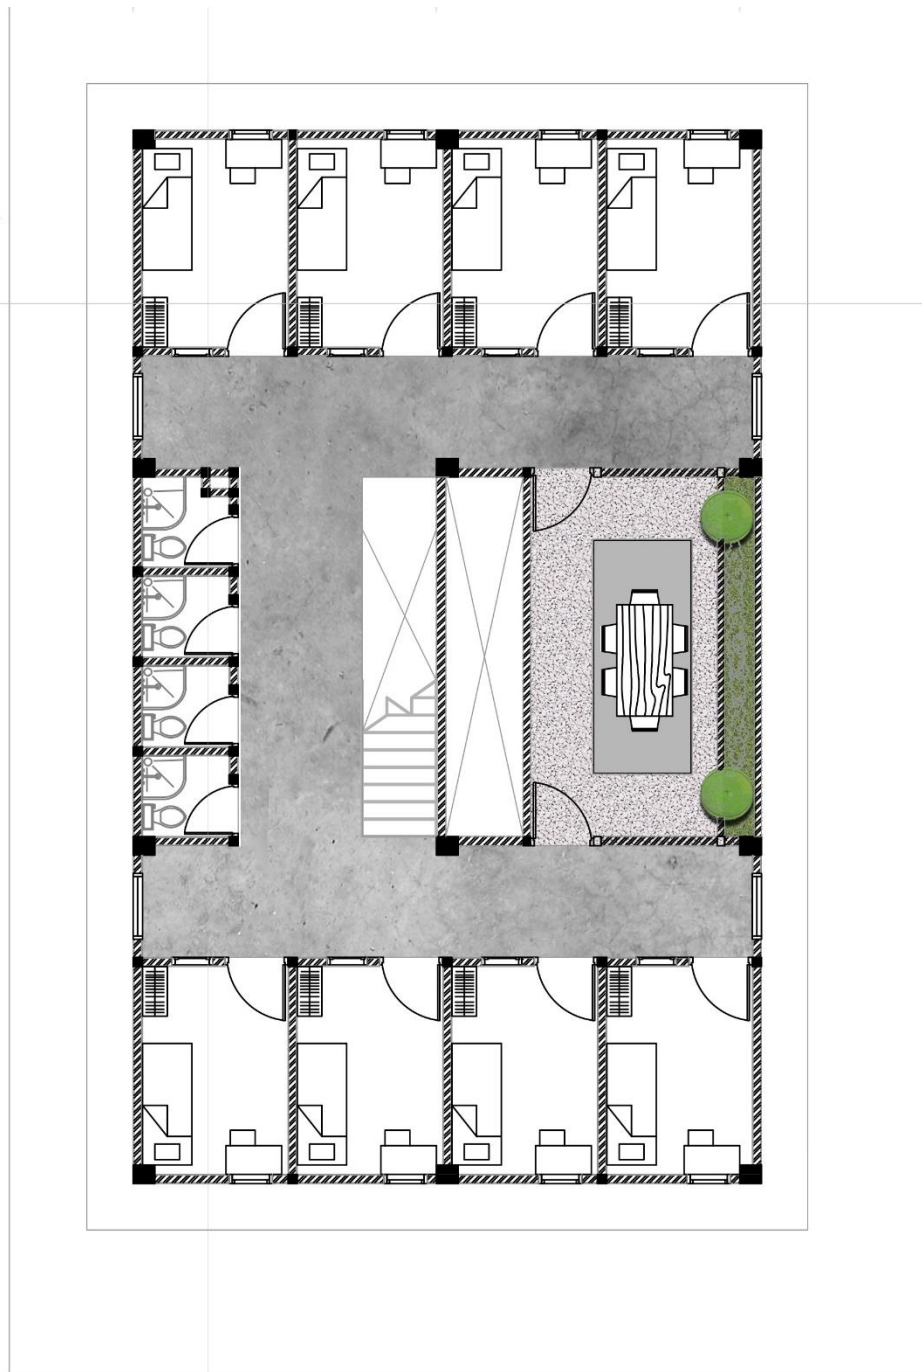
Ruang Hijau di Sekeliling Bangunan
